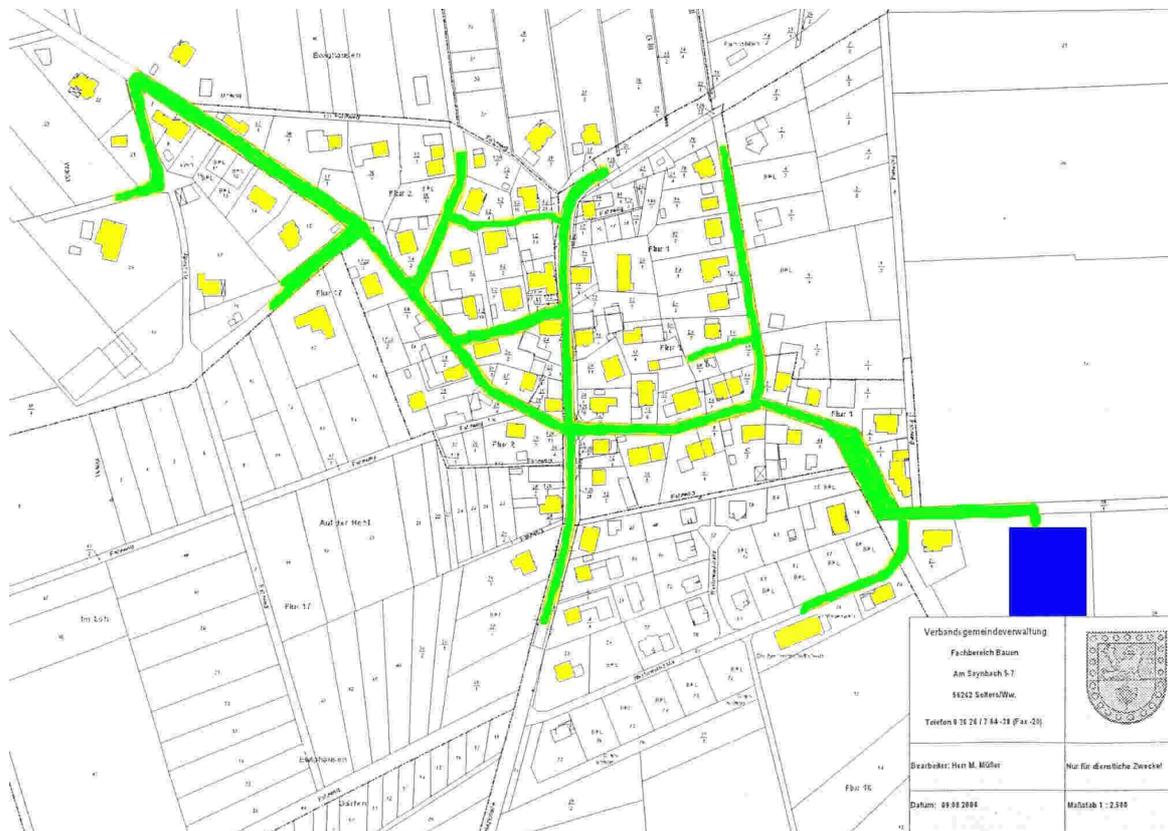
Lageplan Variante zwei mit großem Nahwärmenetz
